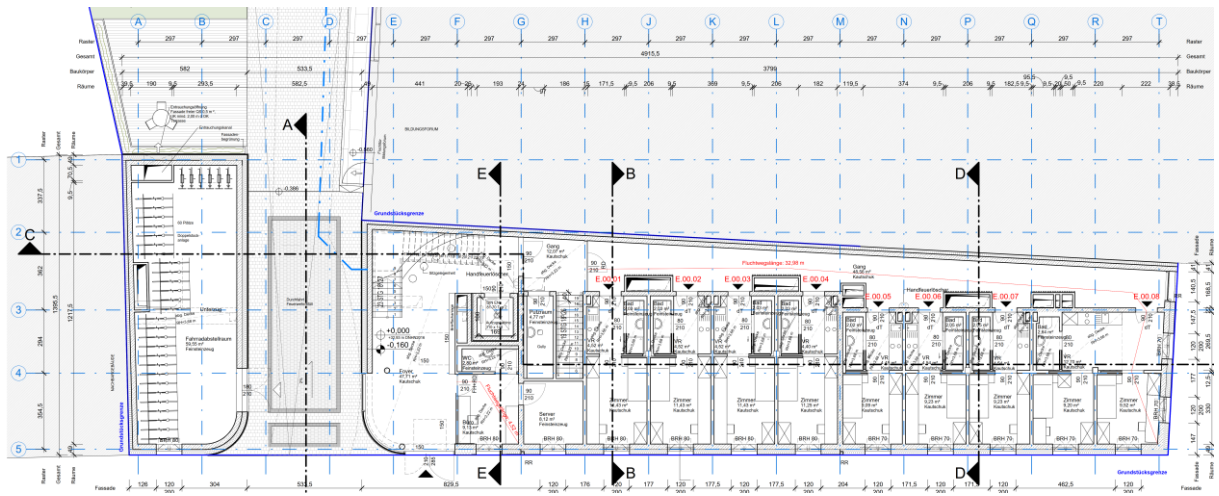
Grundriss Erdgeschoss mit Durchfahrt für die Feuerwehr
